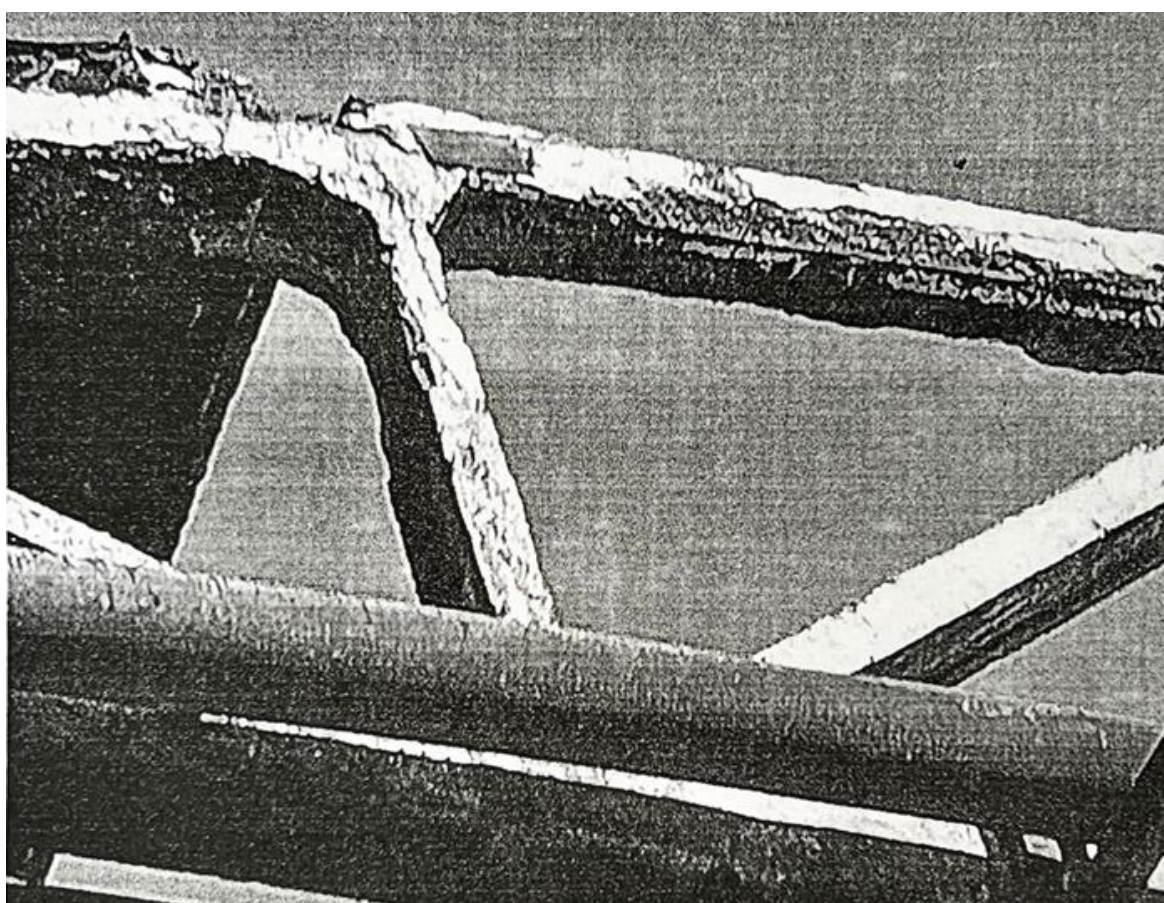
Пошкоджена залізобетонна ферма
